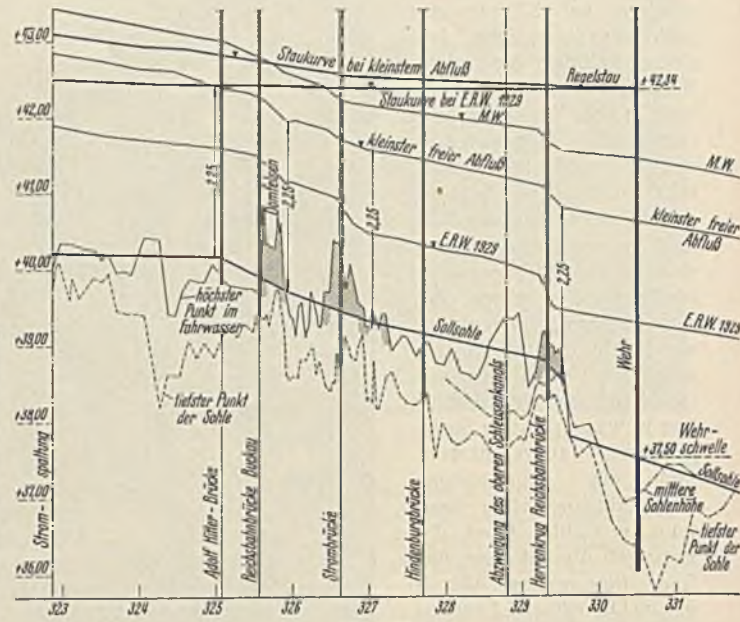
Längsschnitt durch die zu stauende Stromelbe bei Magdeburg.
